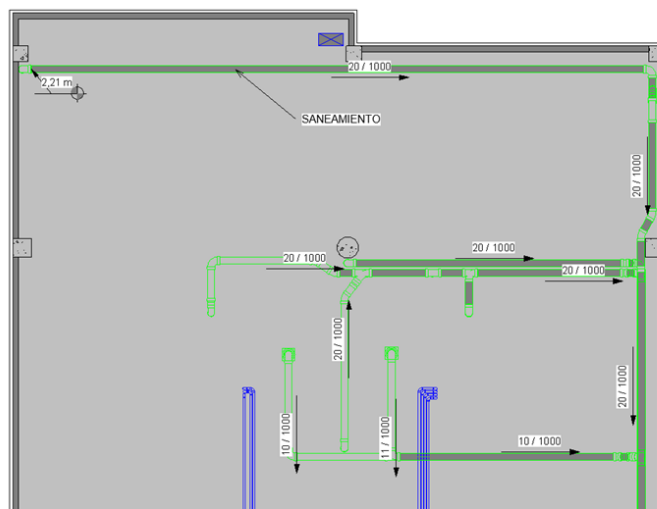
Instalación de saneamiento en planta garaje, modelado en BIM. Fuente:
